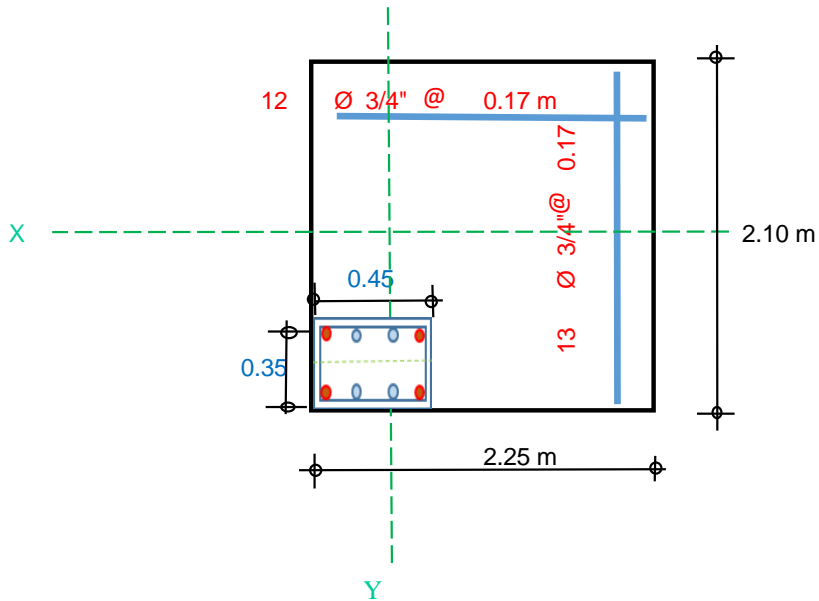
Detalle de planta de la zapata esquinada (Estructura 1).
